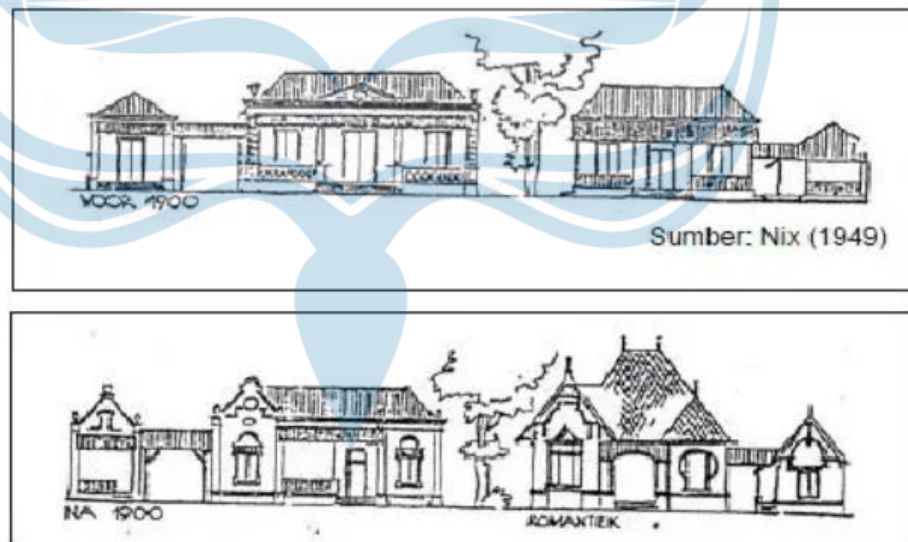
8: Denah dan Tampak Depan Bangunan *Empire Style
